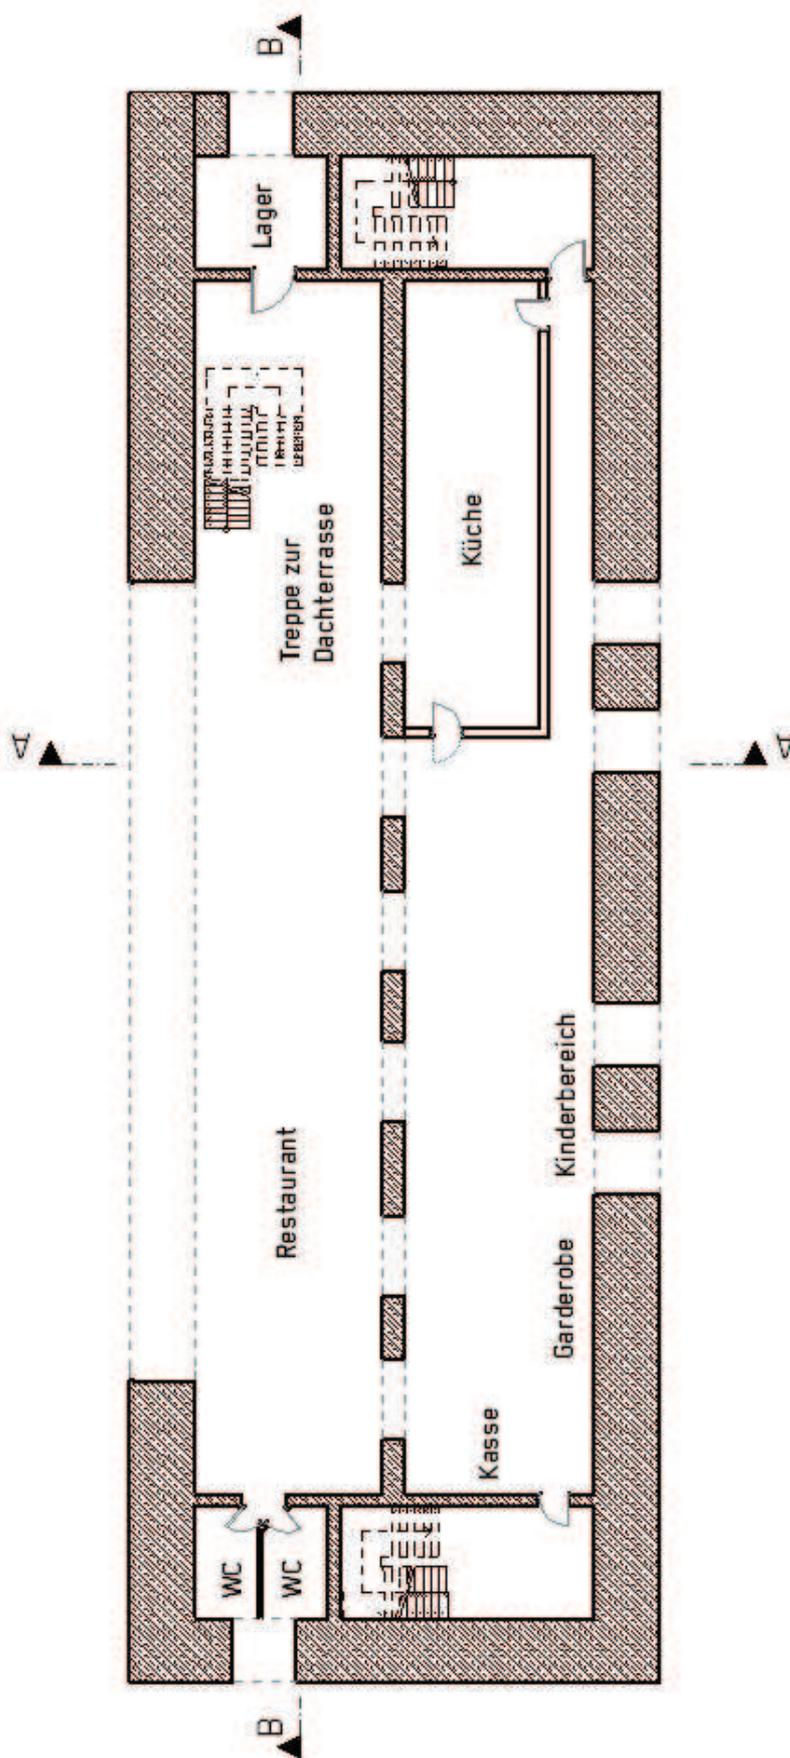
, Grundriss 1.Obergeschoss
